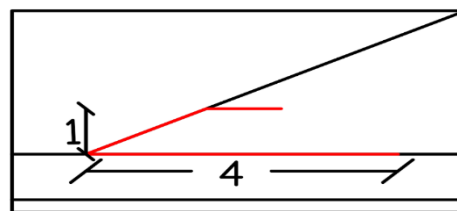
Panjang Geotekstil Berdasarkan Perhitungan Stabilitas Terhadap Guling Pada Lereng Timbunan 6 m
